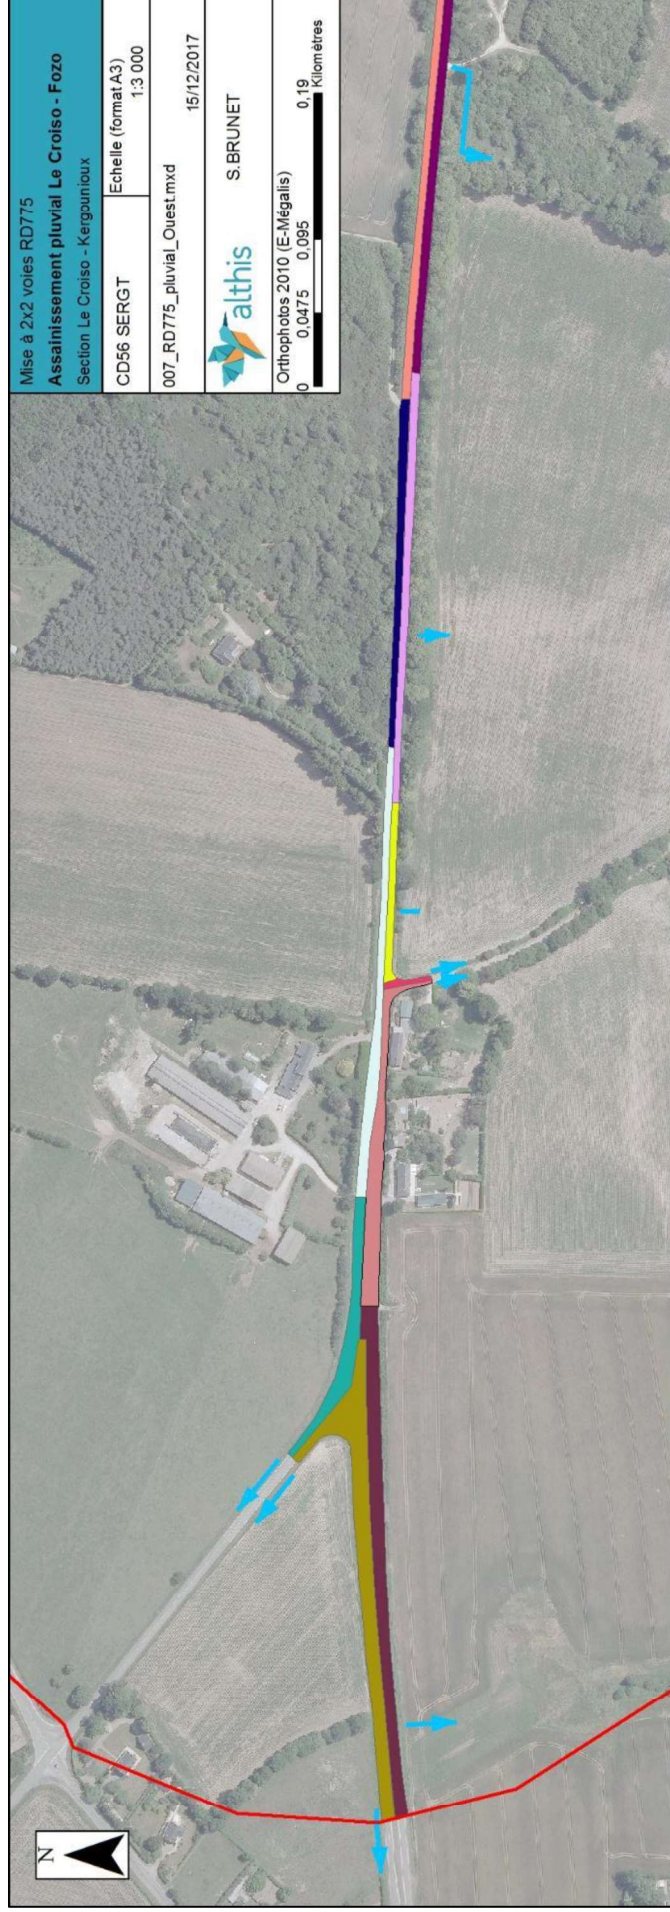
Assainissement pluvial de la plateforme existante – partie ouest
